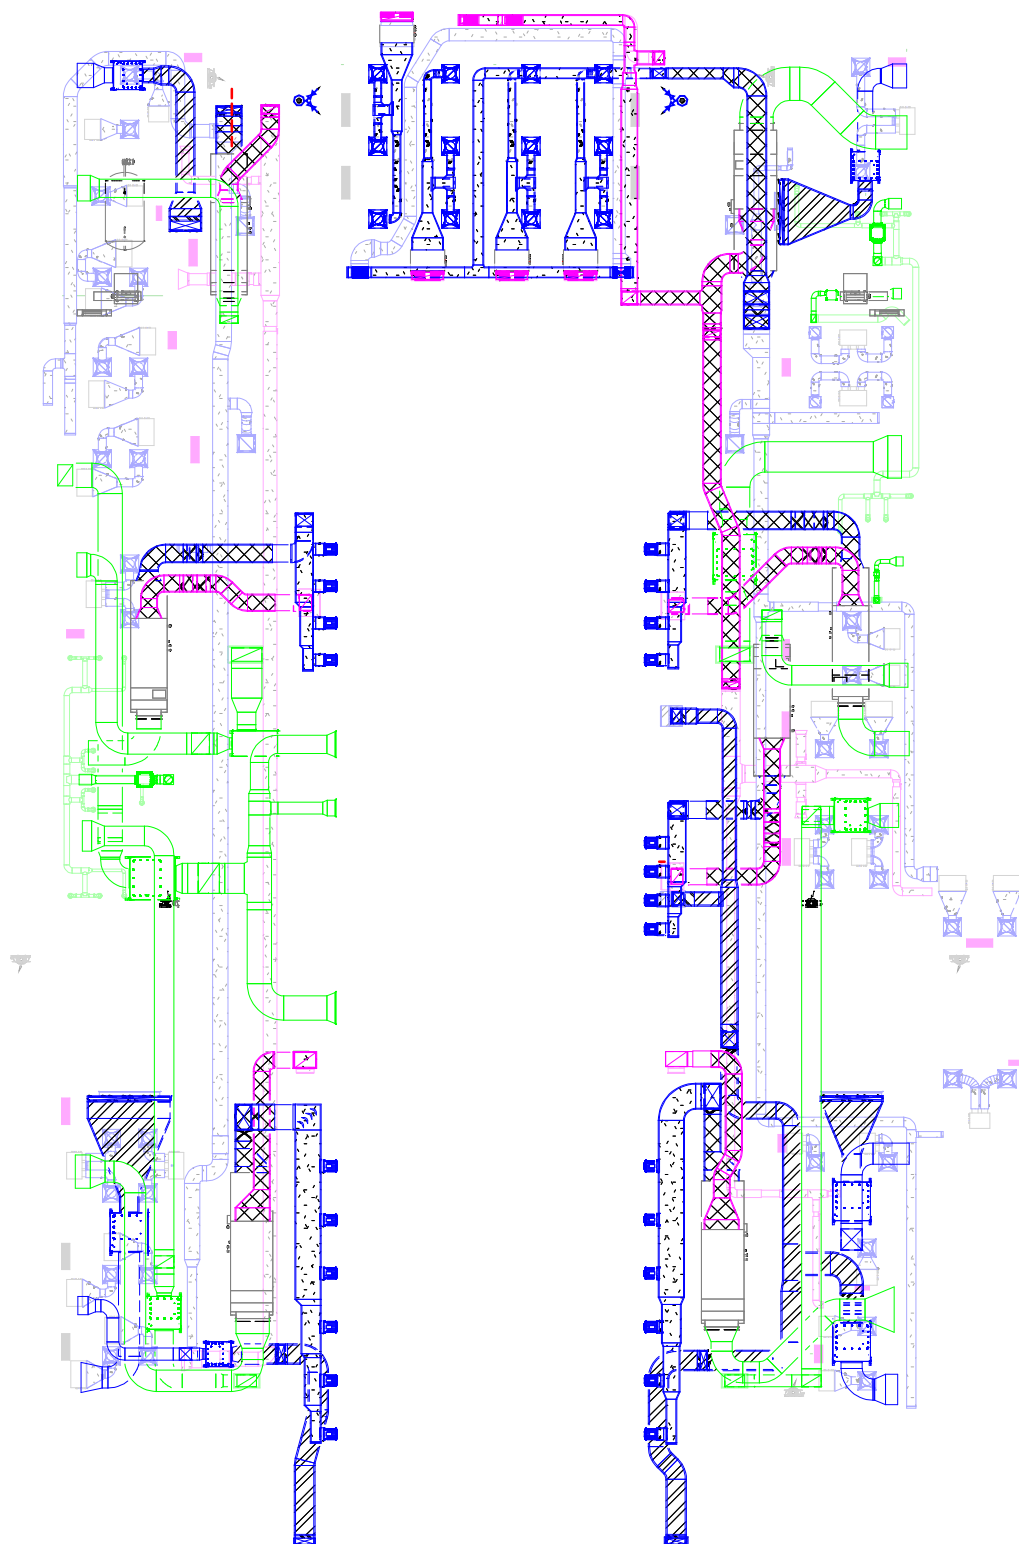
Planta geral do traçado das condutas na *mezzanine* à escala 1:250.
